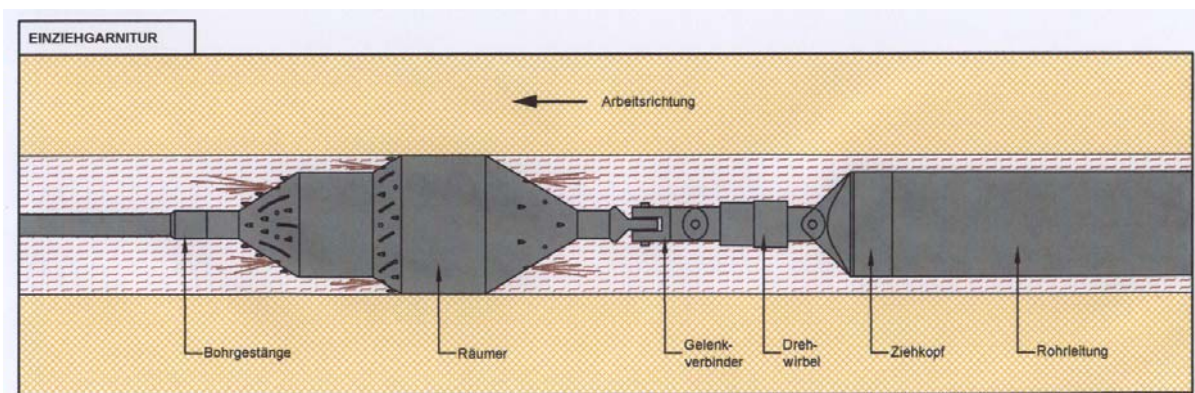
Pullback-Assembly für HDD-Bohrungen [4-15].
